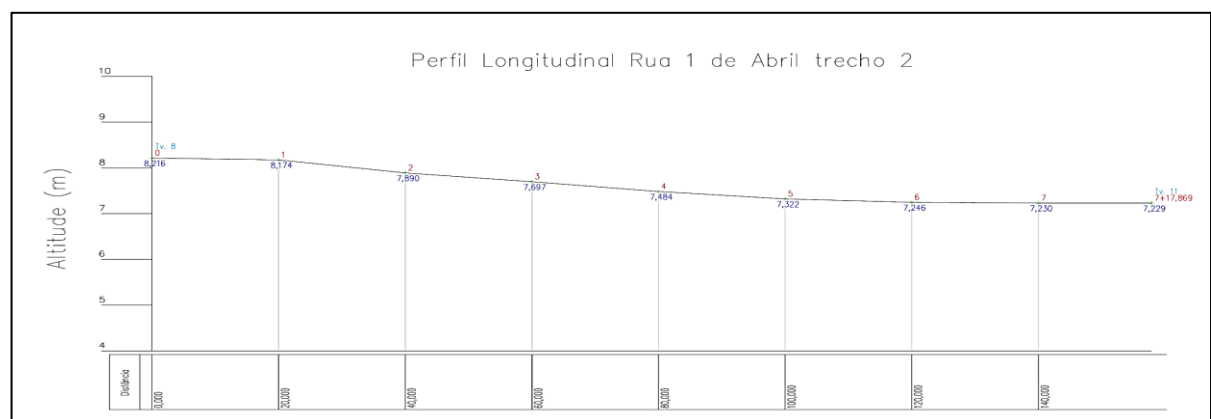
Perfil longitudinal Rua 1º de Abril (trecho 2)
